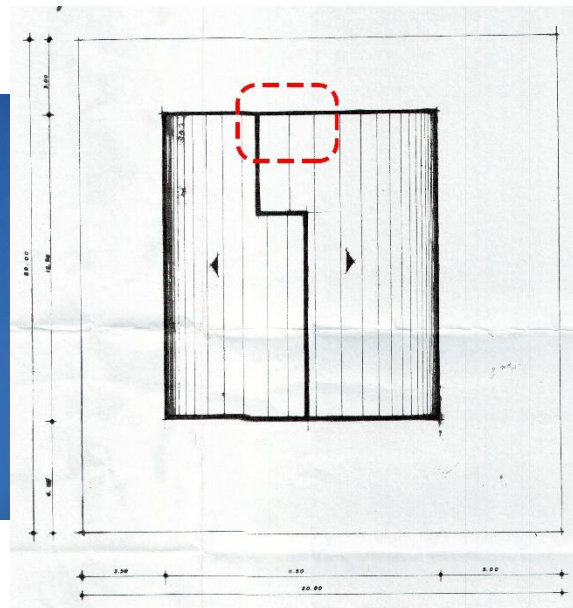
Tanque Elevado – “Vivienda del Sr. Walter Santos”.
